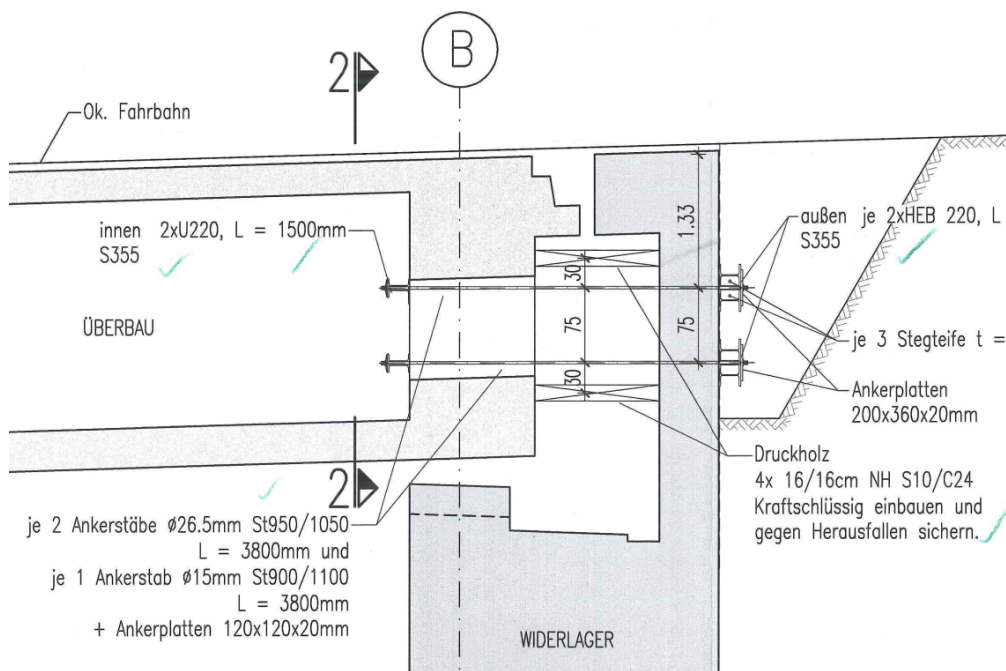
Darstellung der Festhaltung in Längsrichtung als Planauszug des Ausführungsplans (© HOCHTIEF)
